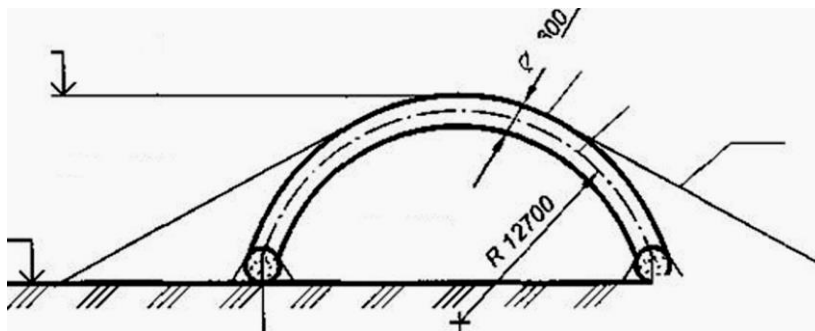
Пневматический склад с несущими пневматическими арками
